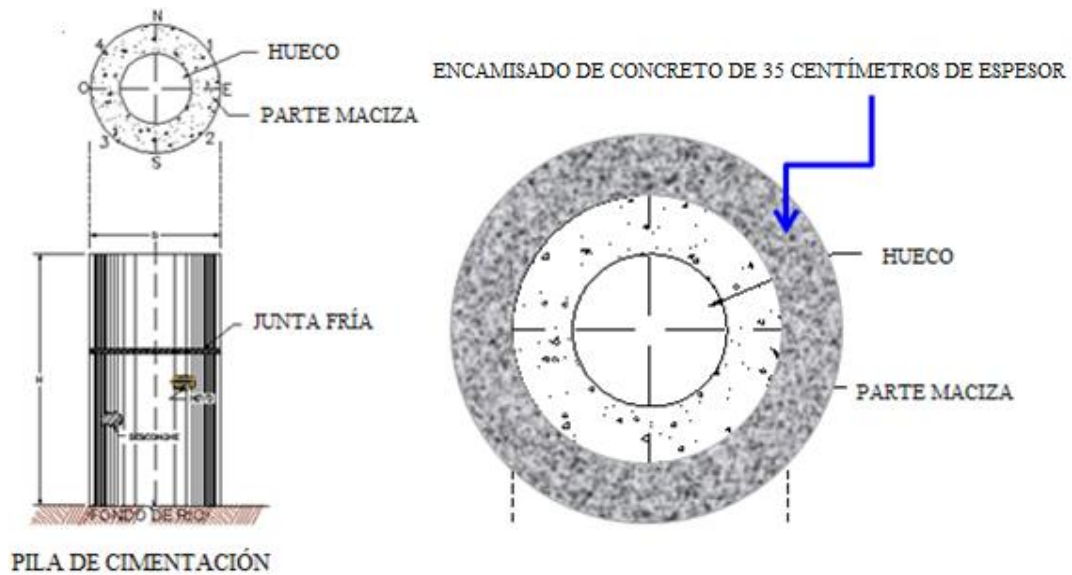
Intervención en las pilas de cimentación en los ejes 12 y 13 [1.3].
